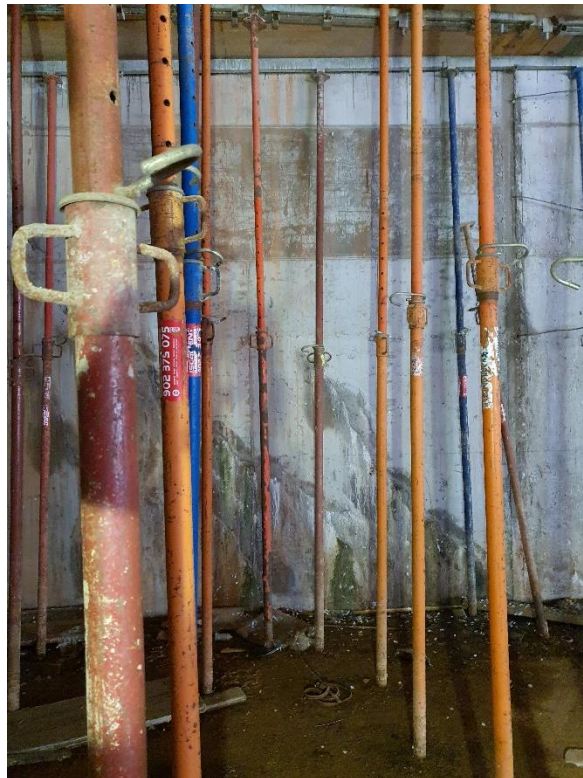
Vista general donde se observa fisura inclinada con eflorescencias por sales. También, se aprecia moho y hongos. Muro 6.
